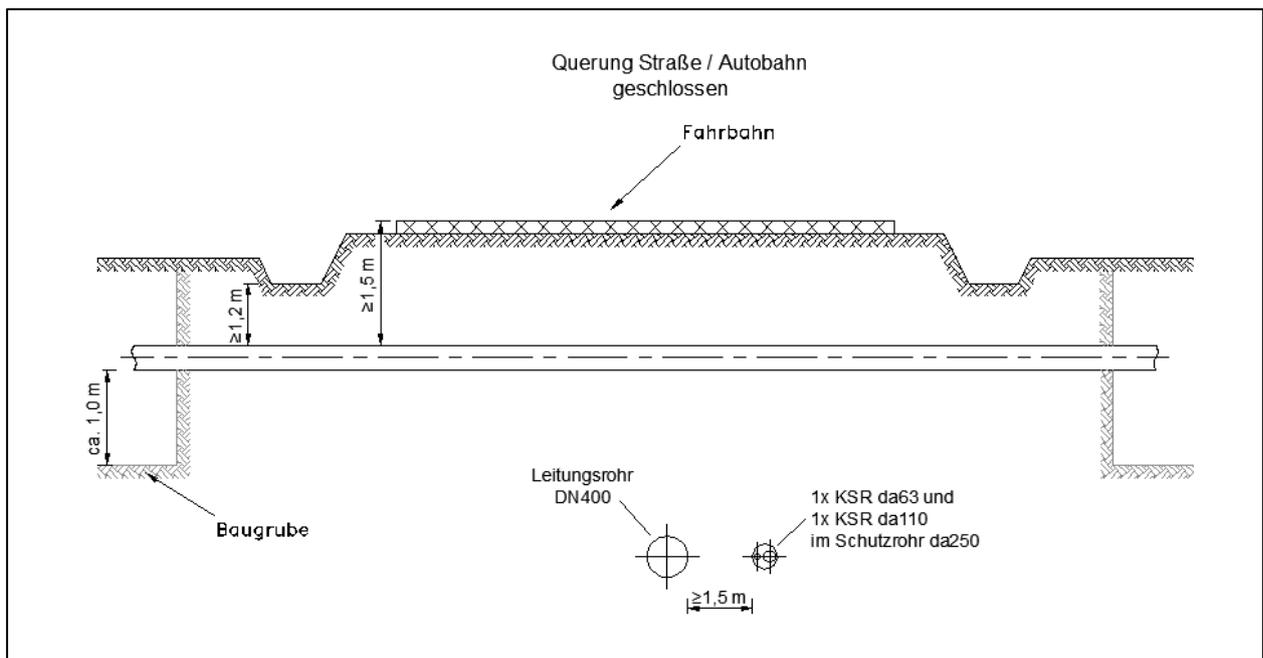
Typenplan Straßenquerung in geschlossener Bauweise
